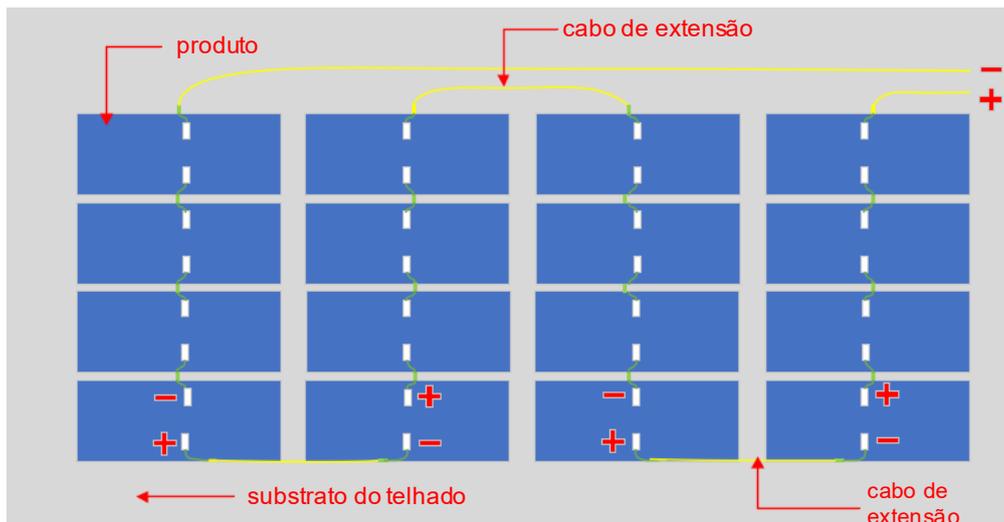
Instruções de operação da conexão do jumper do produto (vista frontal)
